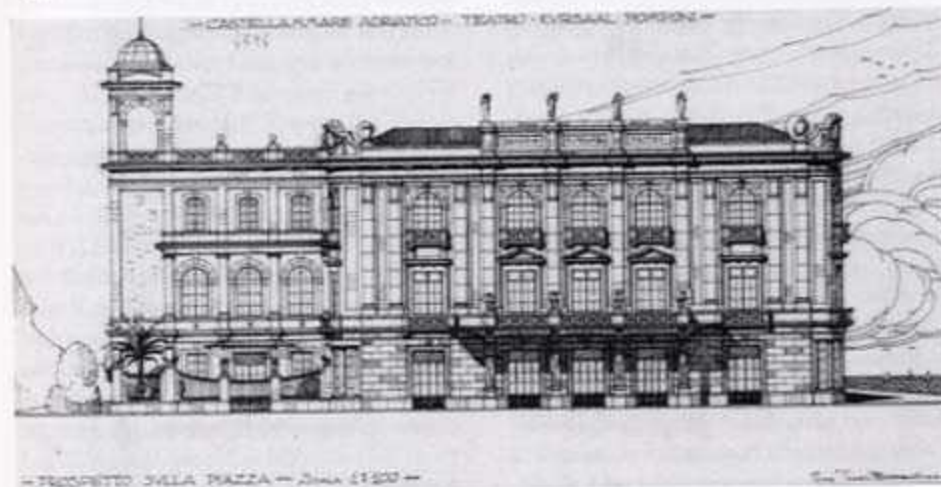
T. Pomponi. Pescara. Progetto del teatro-kursaal. Prospetto su piazza Vittoria (ibidem).
